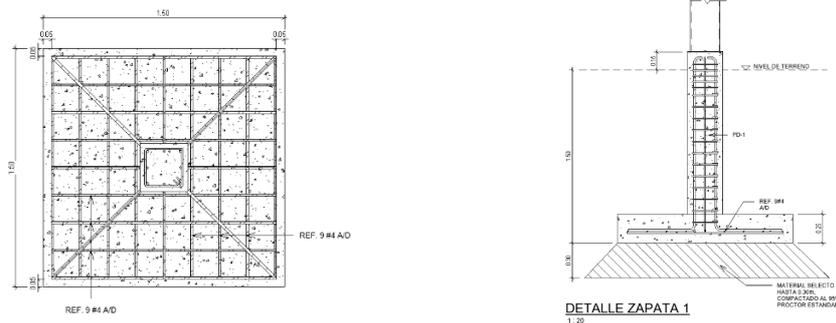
Estructura de fundaciones y viga asísmica, fuente: elaboración propia.
